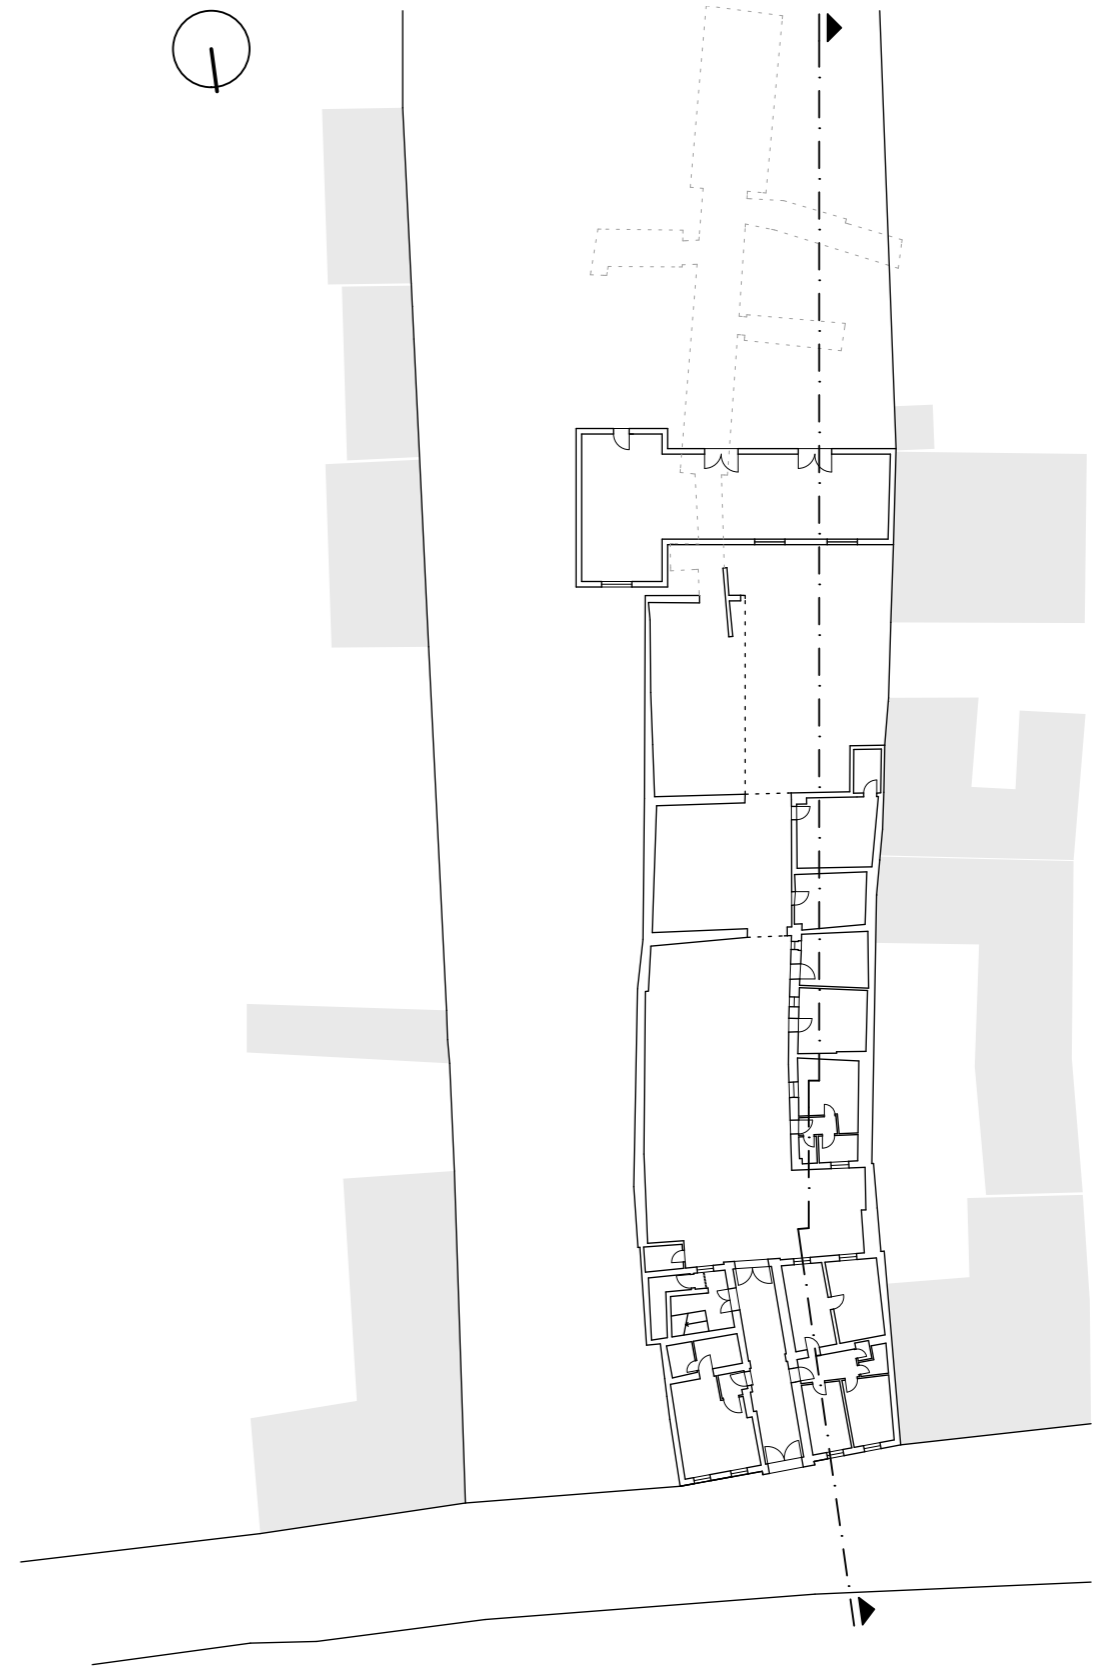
Grundriss Liegenschaft 1:500
